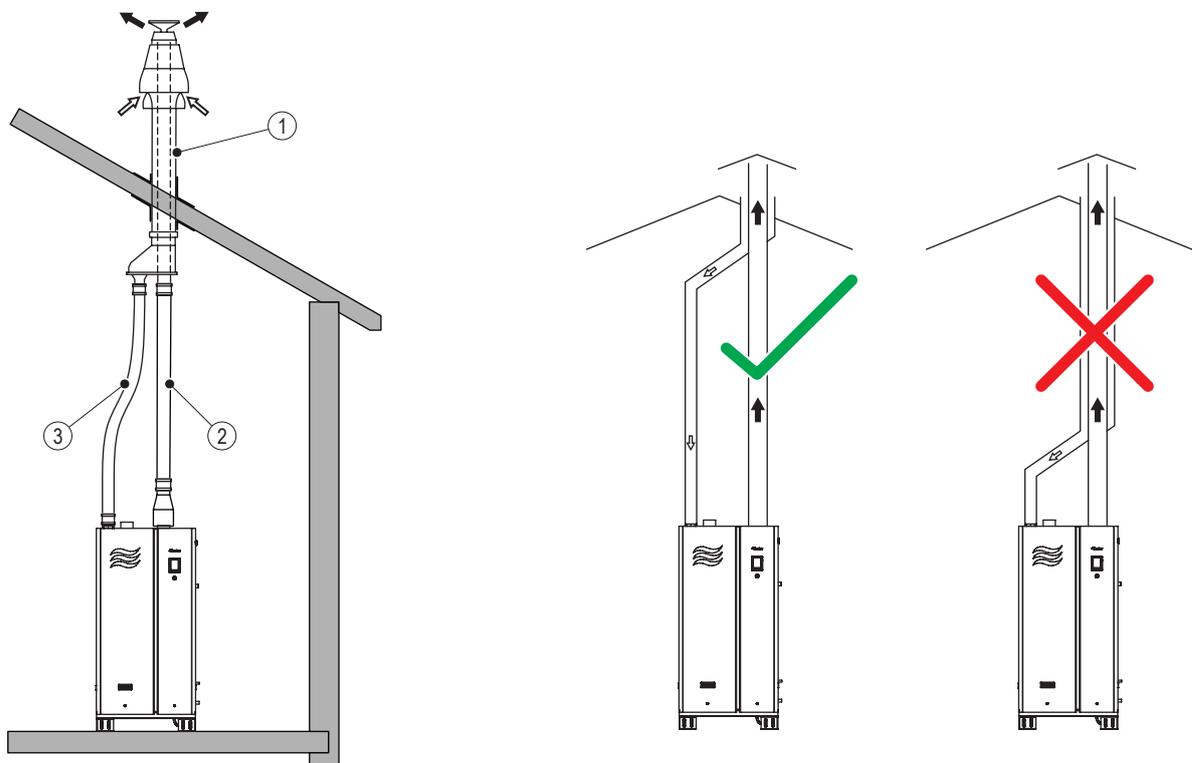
Type 33 Abgasabführung für raumluftunabhängige Installationen
